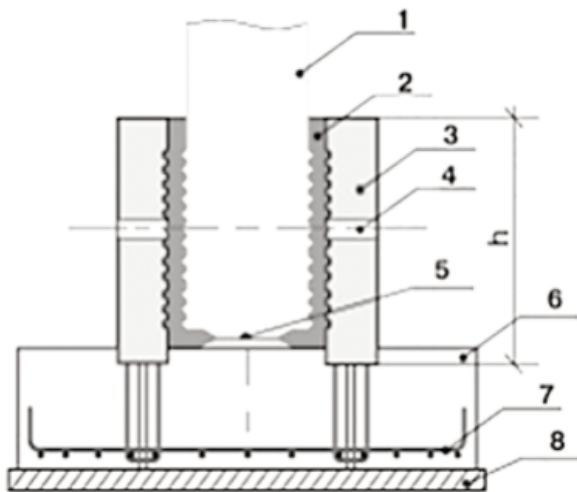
Схема влаштування фундаменту за збірно-монолітною технологією зі збірною підколонною частиною. 1 – колона залізобетонна збірна; 2 – бетон стика колони з фундаментом; 3 - стакан залізобетонний збірний; 4 – отвір для стропування стакана; 5 – підкладка фіксатор для центрування колони при посадці на опору; 6 – ростверк фундаменту монолітний; 7 – арматурна сітка; 8 - бетонна підготовка під ростверк.
